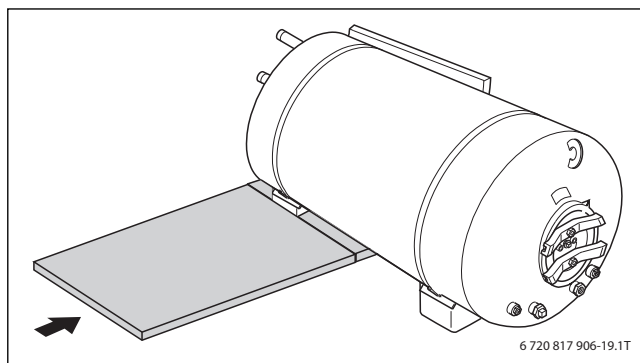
Montáž segmentů tepelné izolace zadní stěny
